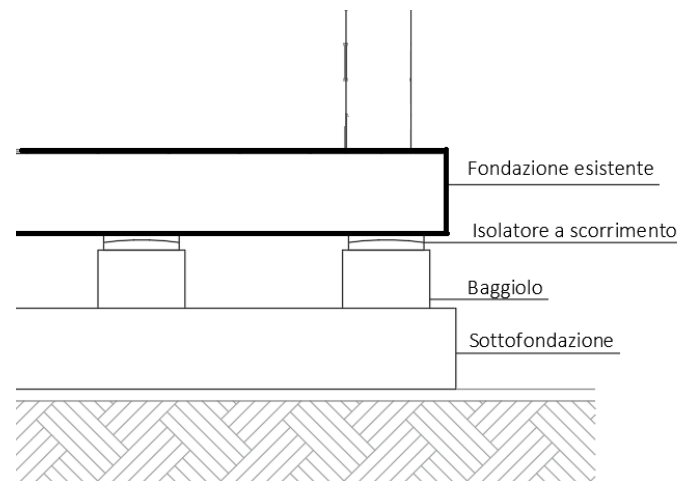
Soluzione di posizionamento tra fondazione e sottofondazione
